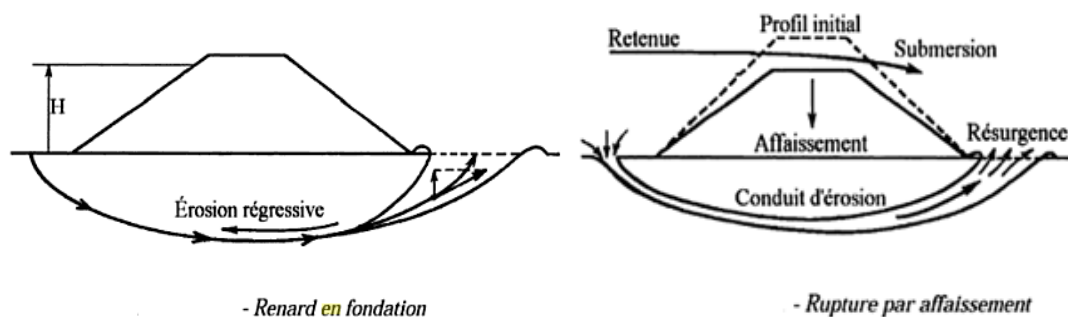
Instabilité hydraulique des barrages en terre (Le Delliou, 2003).
